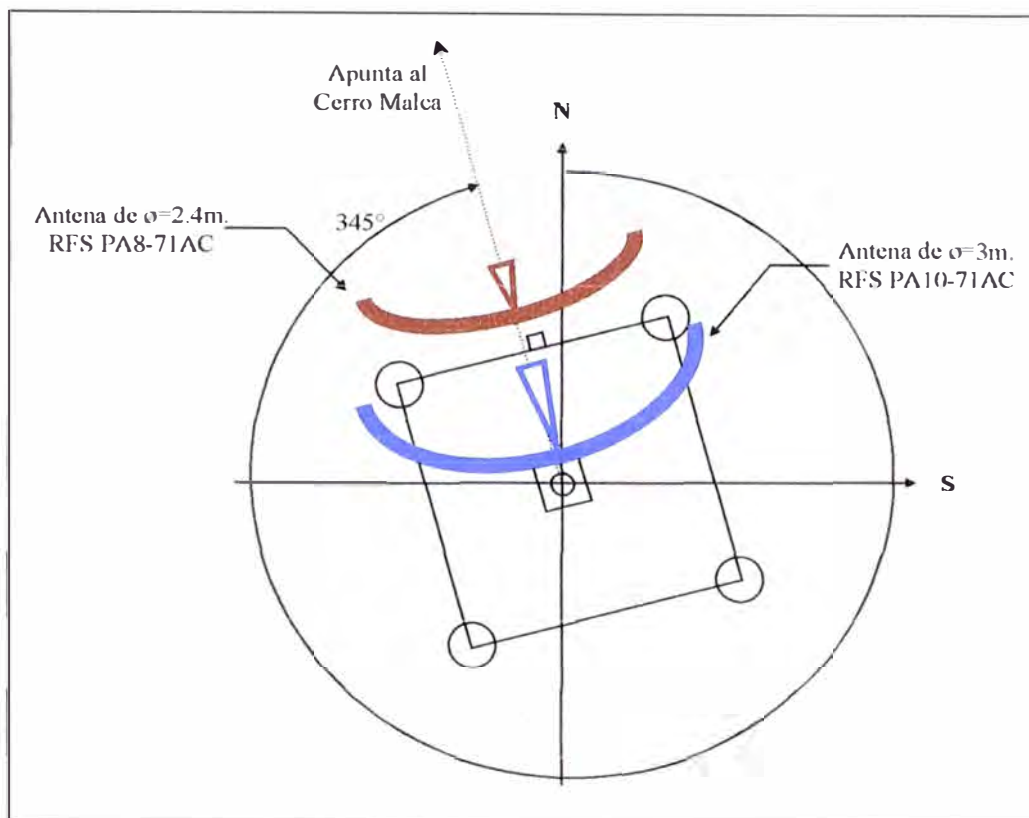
Vista de Planta de la Torre - C.H. Huinco.
